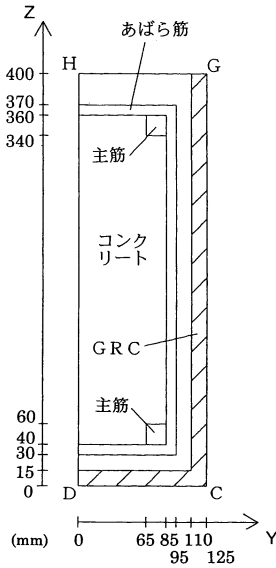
GRC 打込み型枠 RC 梁 Y-Z 断面図
